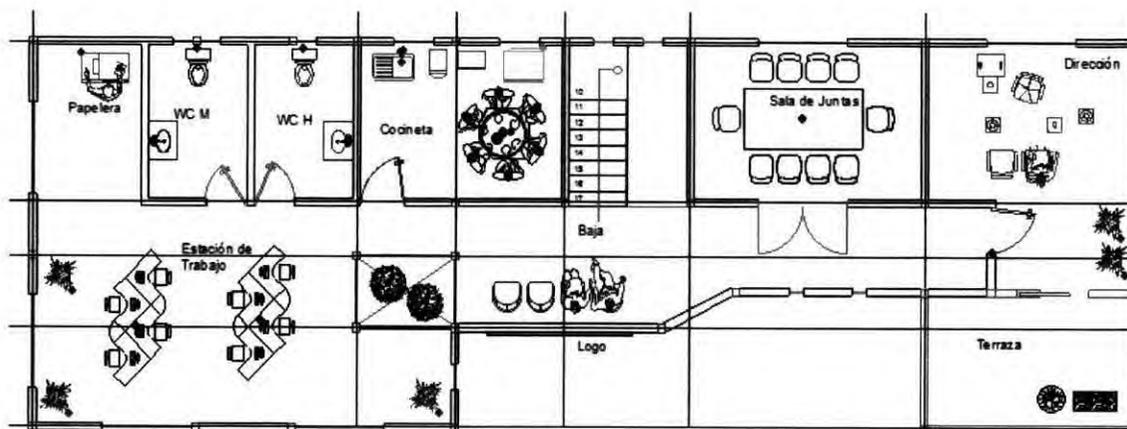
Planta de Conjunto (Proyecto Arquitectónico) de la Estación de NATGAS SUR.
